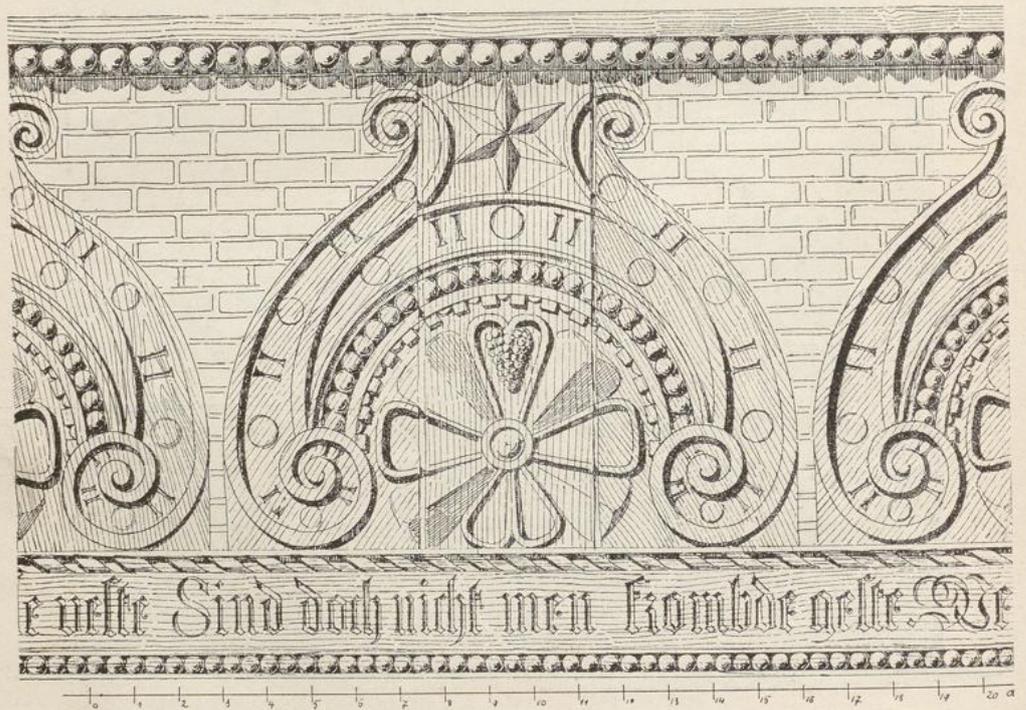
Krahnstraße 7; Brüstung des unteren Giebelgeschosses.
